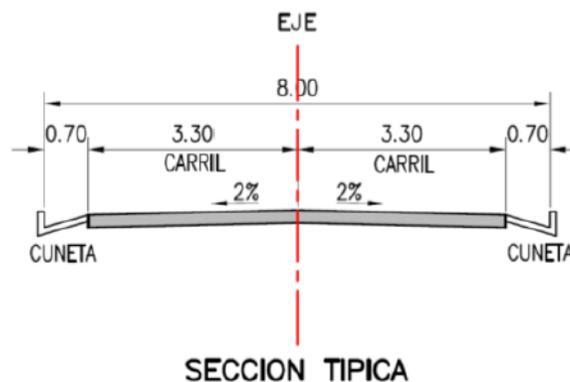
Sección Típica del Pavimento Vía Molinos – Manás.
